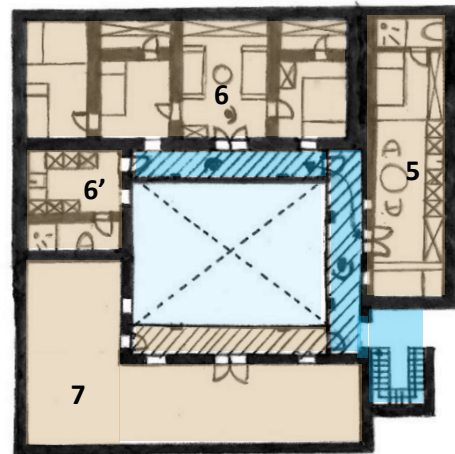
Croquis plan du 1er étage avec segmentation des espaces privés et collectifs agrandi.
